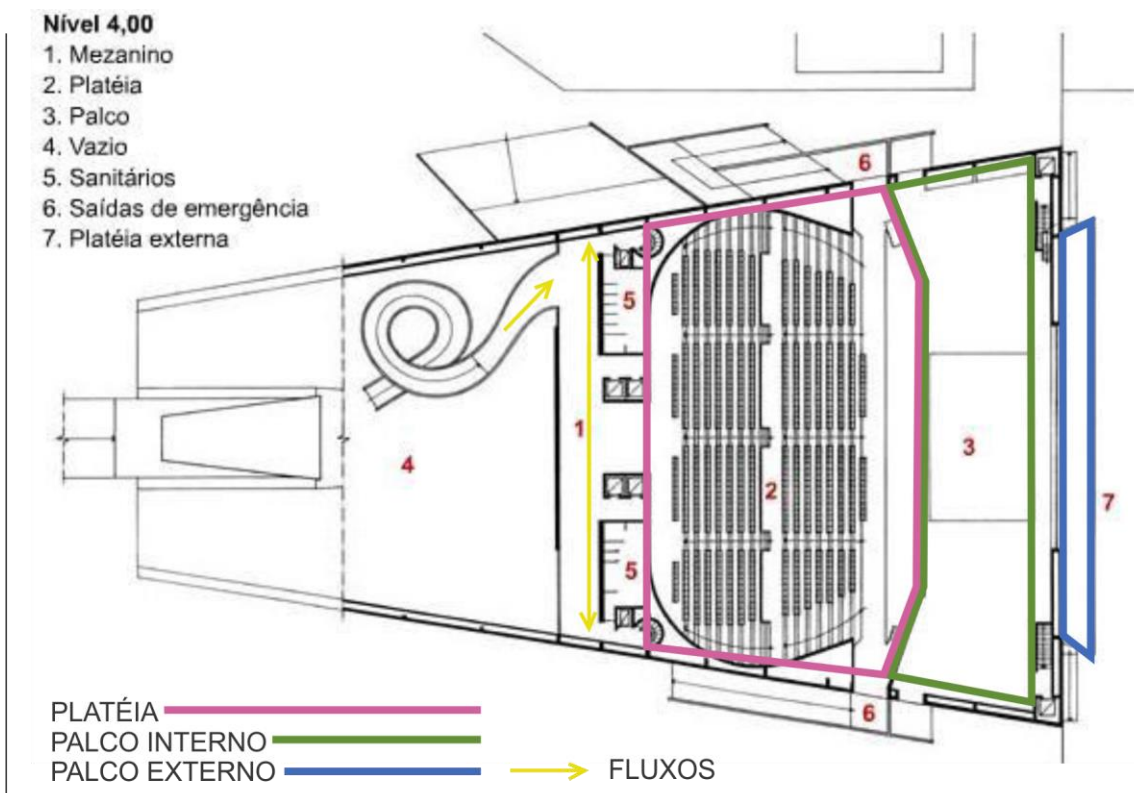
Planta baixa 1º piso, Auditório do Parque Ibirapuera
